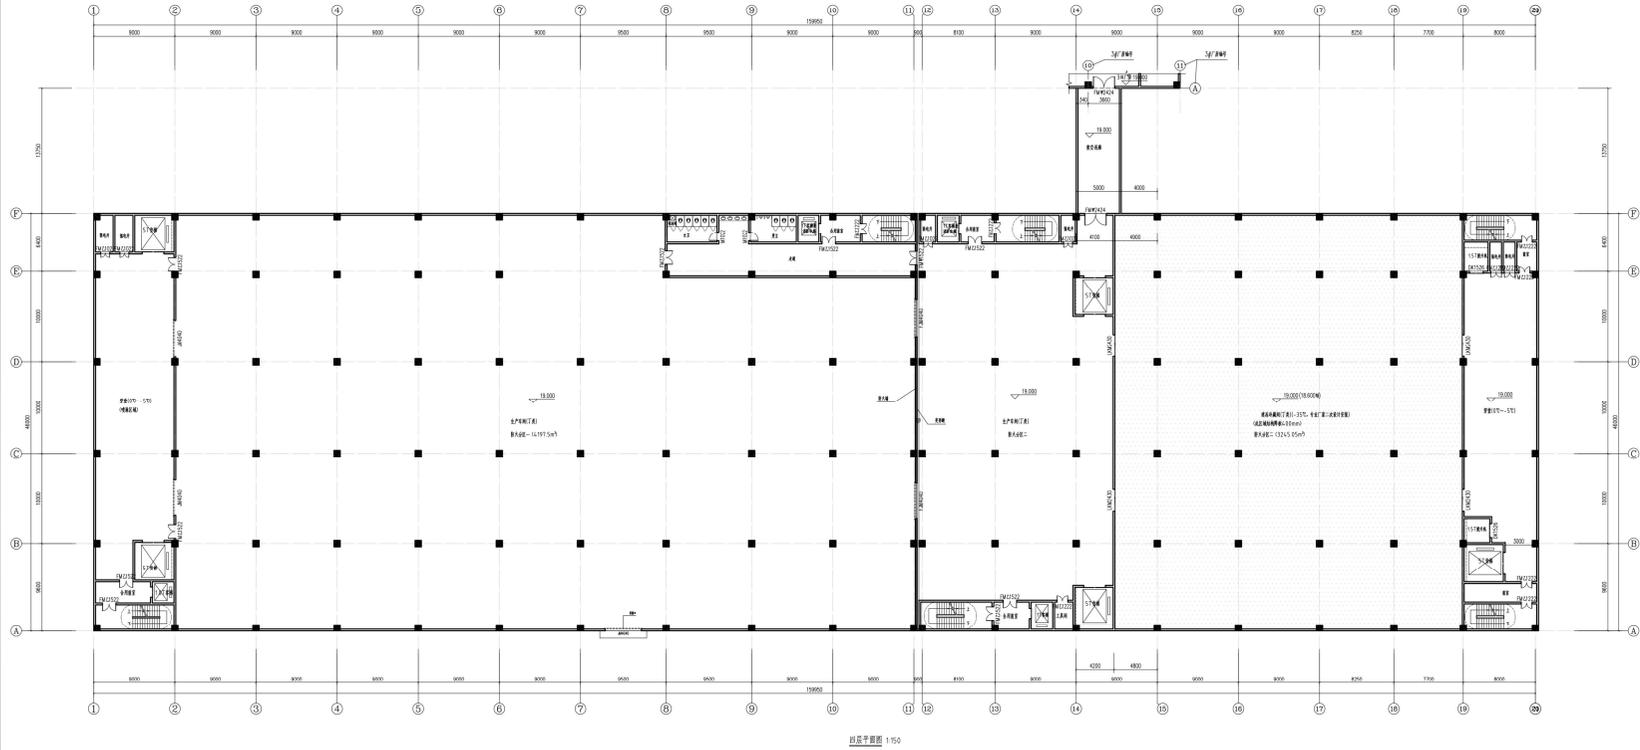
1#厂房三层及 2#厂房四层平面布置图
